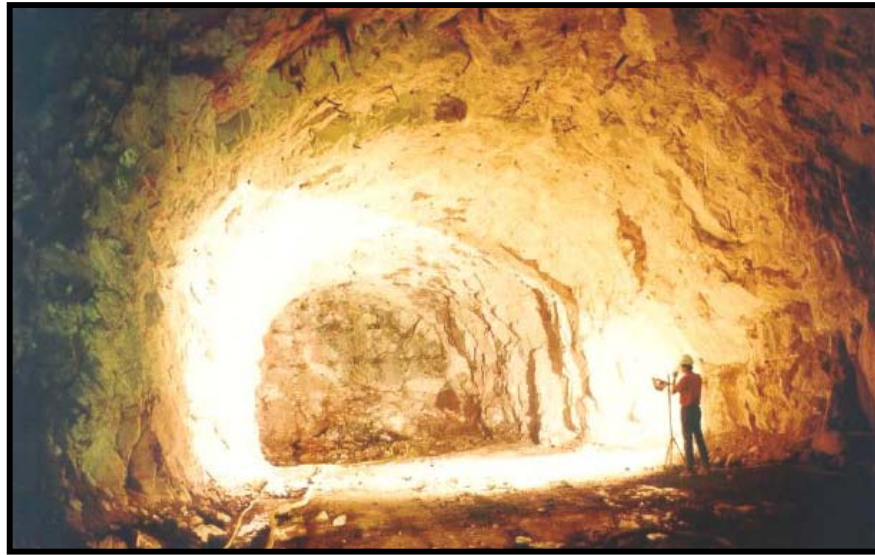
Túnel de acceso auxiliar a tuberías a presión
